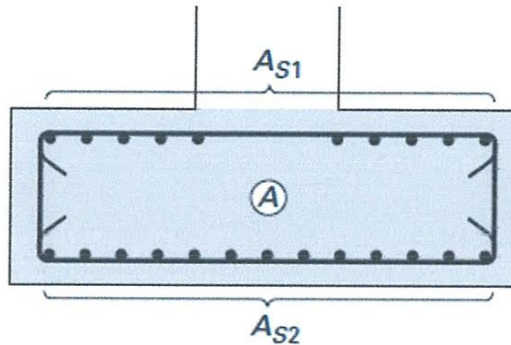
Semelle armée à la flexion (Fascicule 62-V)
